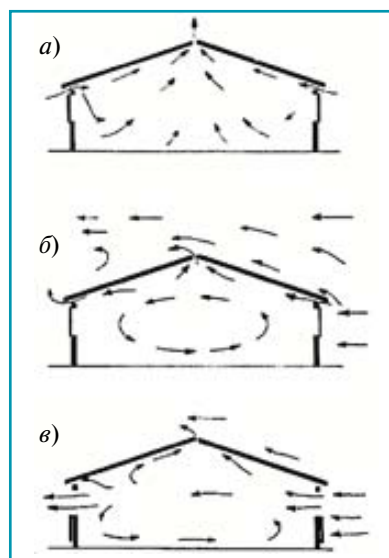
Схема вентиляции «холодного» коровника (вытяжка — через вентиляционную щель в коньке покрытия, приток — через проемы в продольных стенах):
